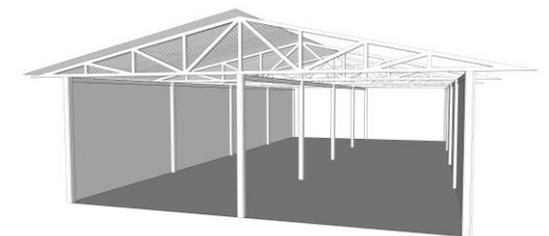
Esquema de estrutura encontrada em galpão. Fonte: Elaborado pela autora.
